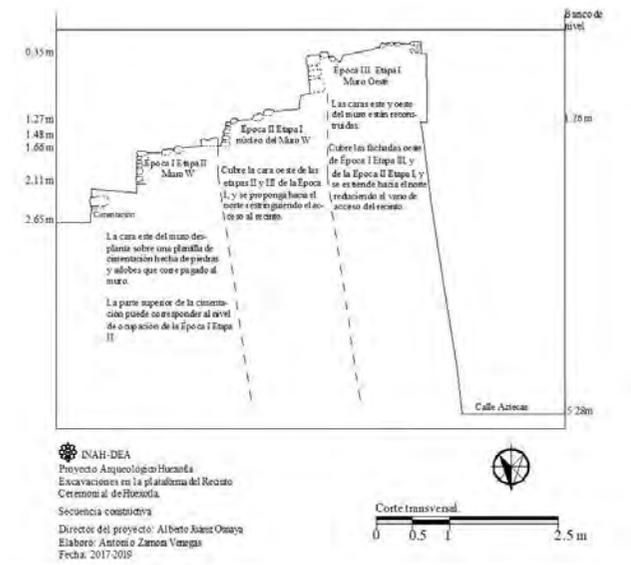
(plano 4) Secuencia constructiva de la plataforma del recinto sagrado, fachada principal. Corte longitudinal.
